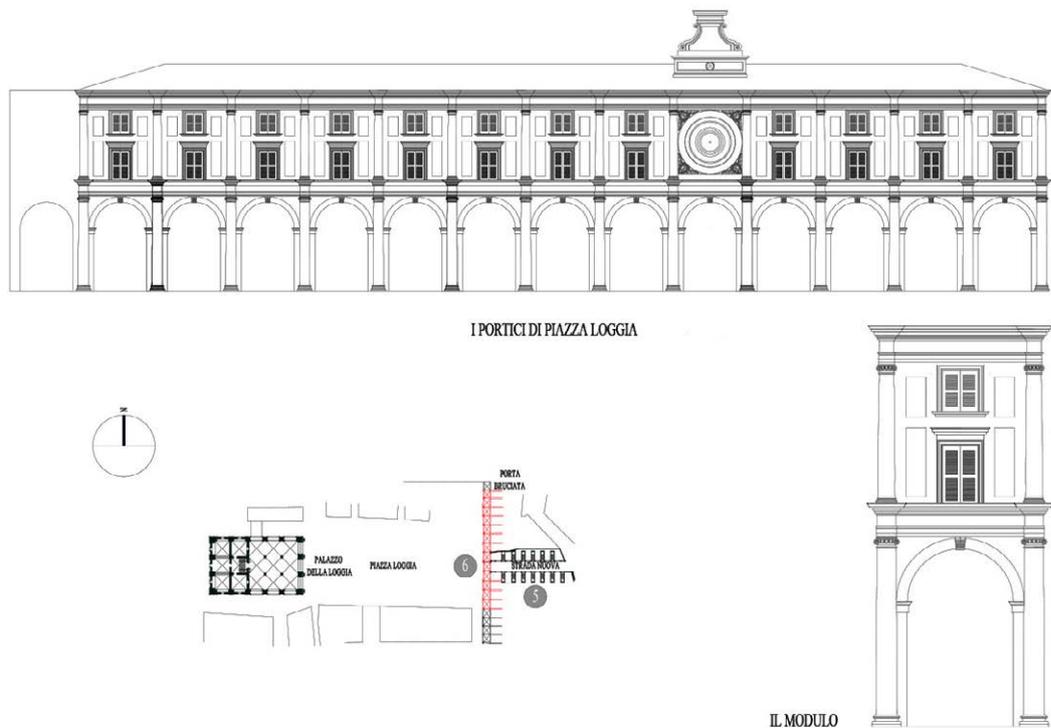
Brescia, portici di piazza Loggia realizzati a ridosso delle mura occidentali della Cittadella Nuova: ortofoto, pianta e prospetto. Elaborazione degli autori.
